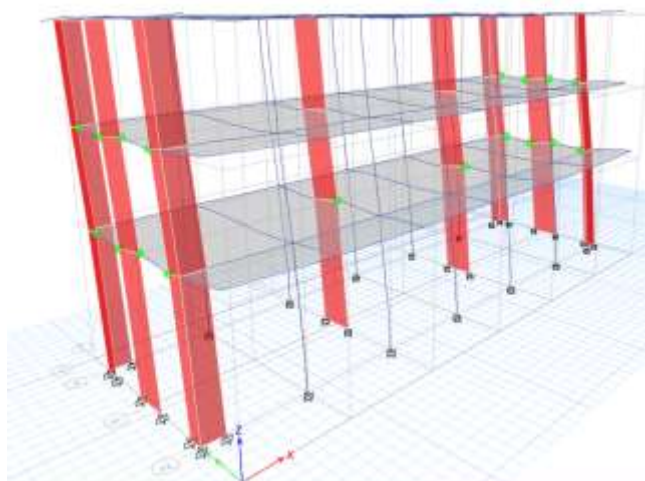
Estado de rotulas plásticas dirección Y para un desplazamiento objetivo de 2.1cm
